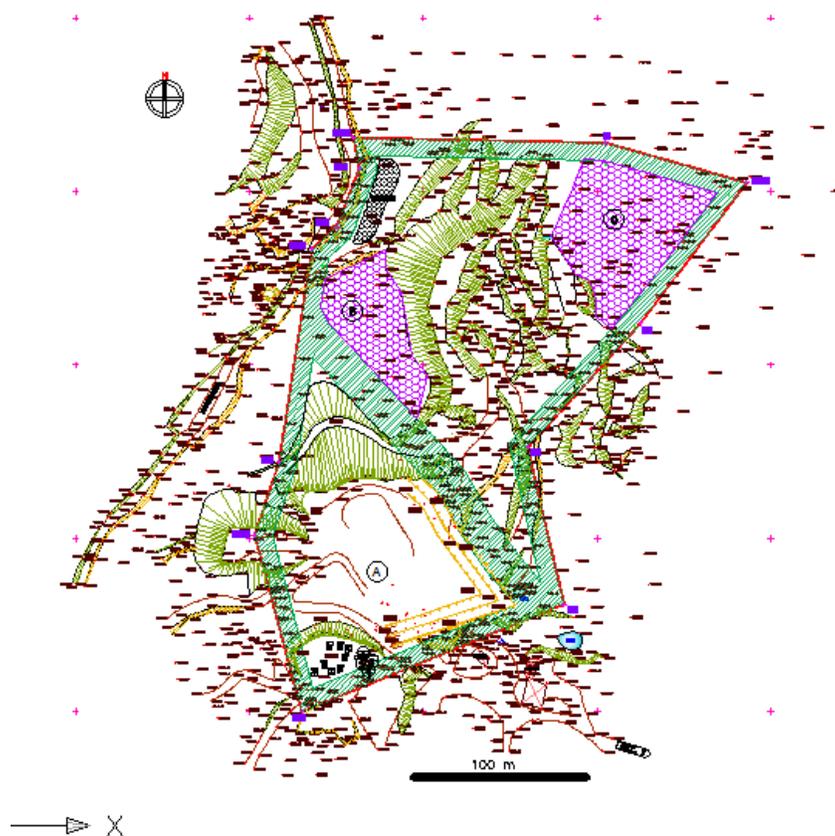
Configuração prevista para a lavra no final da fase II.
